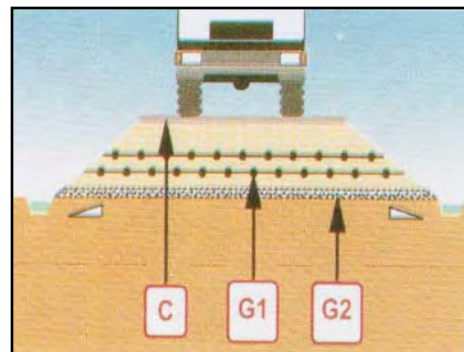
ESQUEMA DEL REFUERZO DE UN RETTAPLÉN. C: PAVIMENTO; G1: GEOMALLA BI-ORIENTADA; G2: GEOCOMPUESTO
